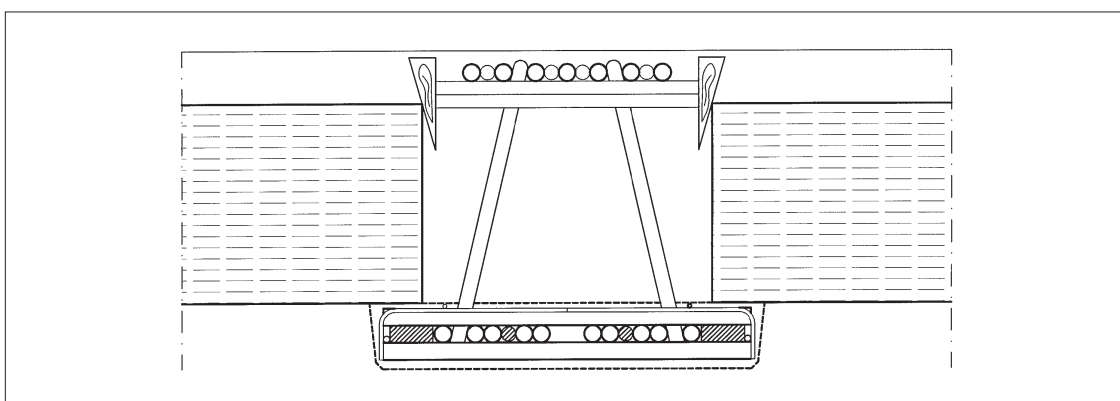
Struttura trasversale in acciaio (sezione).
